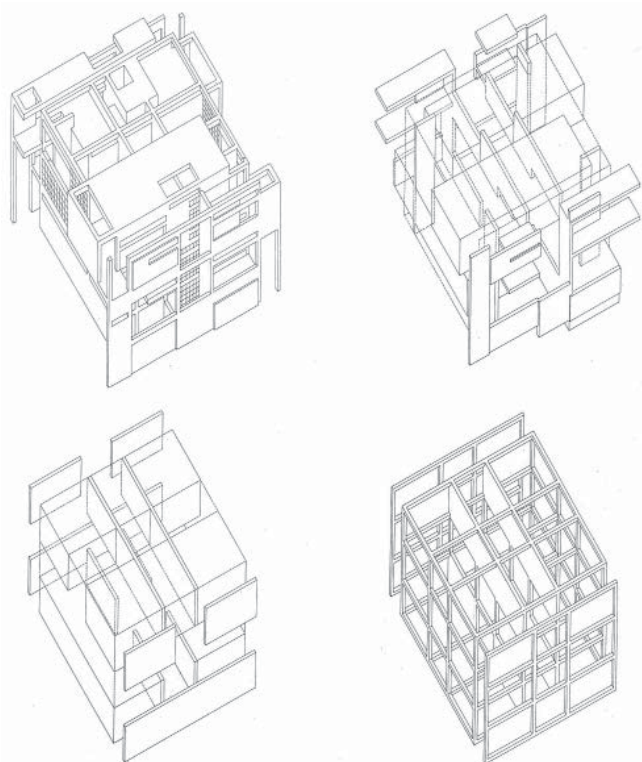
Immagine/dispositivo. House IV progetto di Peter Eisenman. 1971, Falls Village, Connecticut. CIORRA, P., 1998, p. 44.
